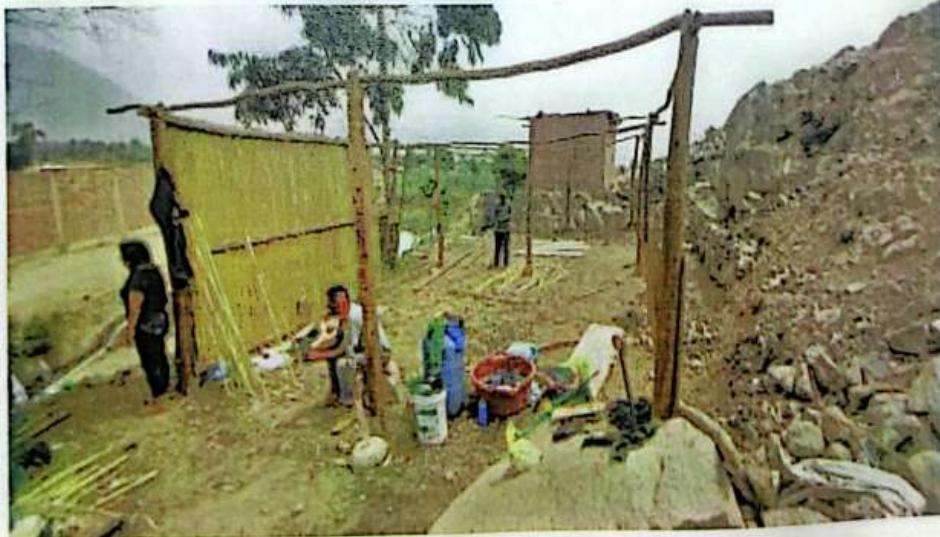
Vista del proceso de construcción de la estructura precaria 2, donde se removió tierra para instalar los 11 postes como pie derecho. 14.02.2023 y al fondo estructura de material noble 1 de data antigua.
